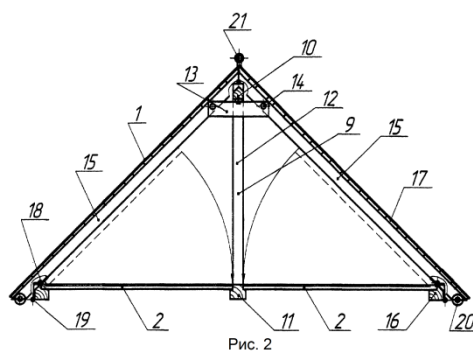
Двускатная крыша с откидными панелями потолка: 1 – крыша; 2 – панель потолка;
